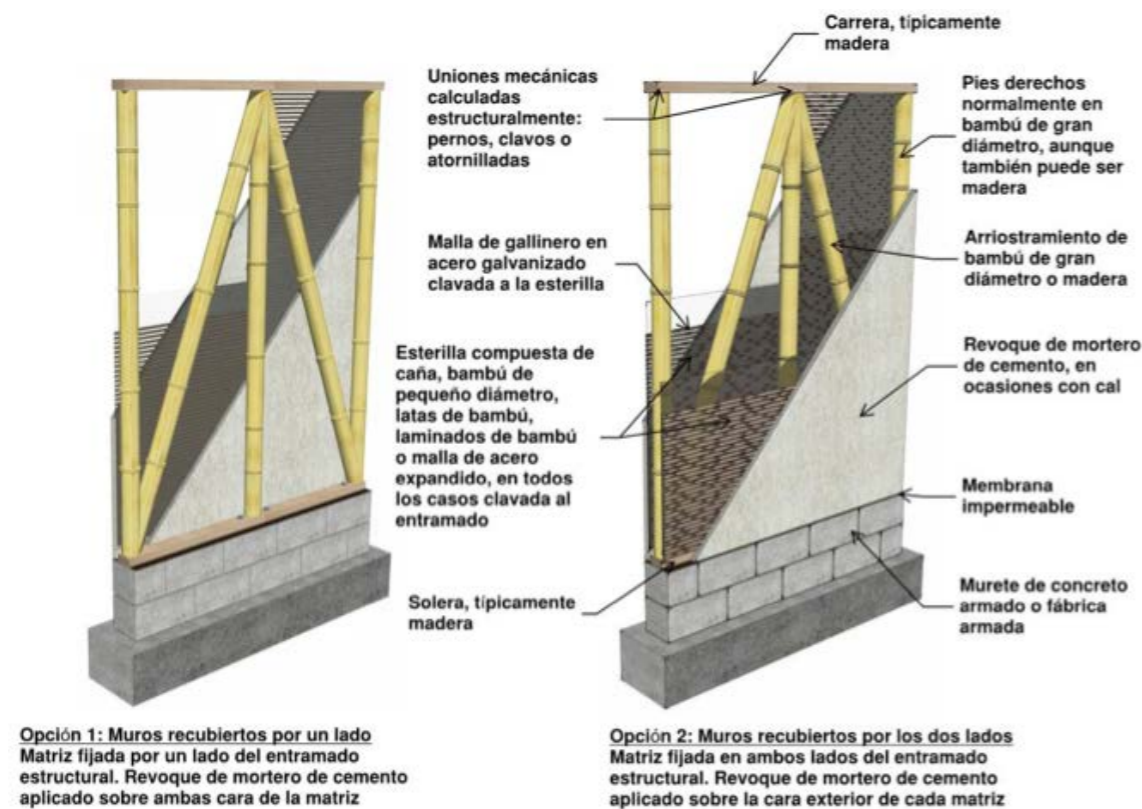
Características de una vivienda moderna de bahareque encementado bien diseñada: detalles del sistema de muros.
